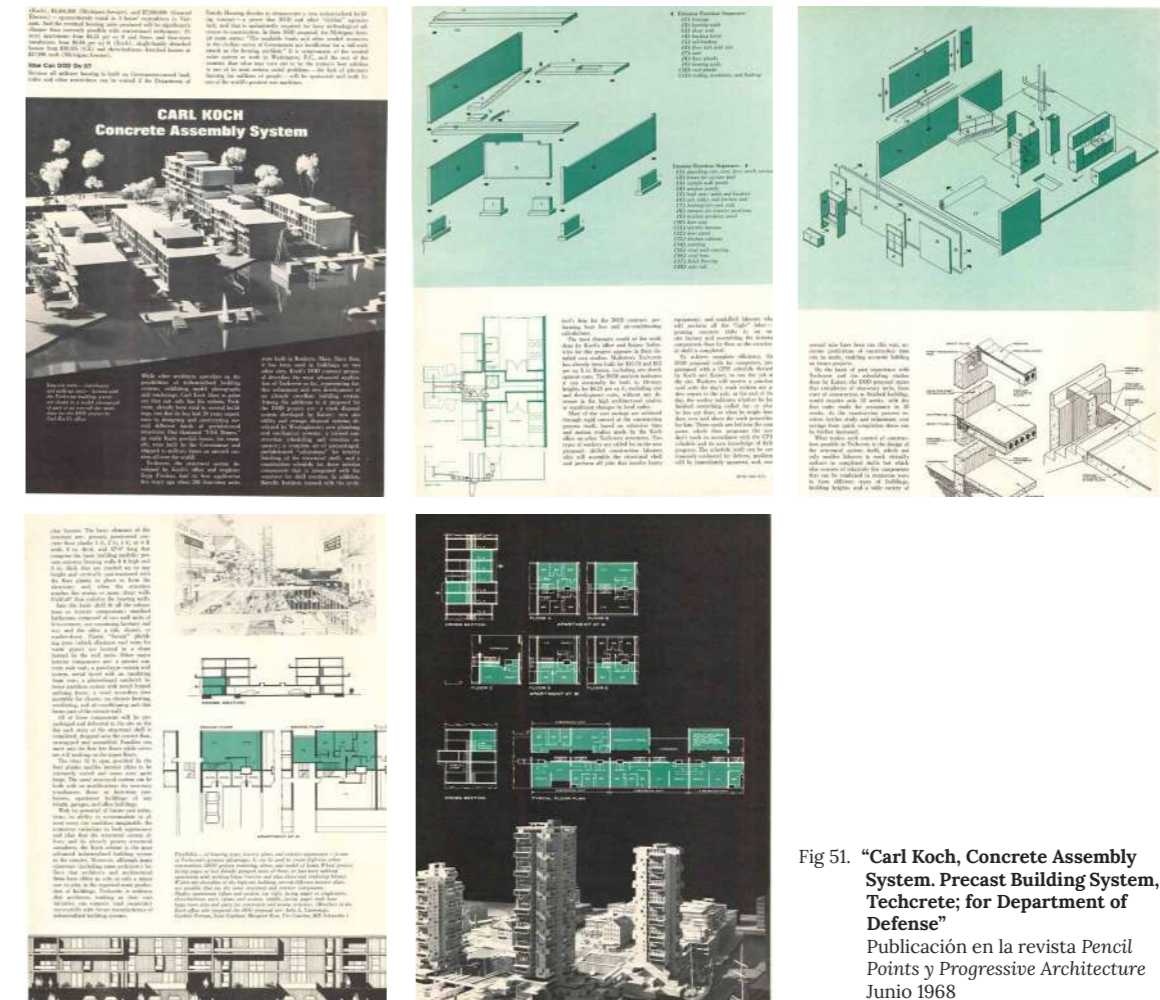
"Carl Koch, Concrete Assembly System. Precast Building System, Techcrete; for Department of Defense" Publicación en la revista *Pencil Points y Progressive Architecture* Junio 1968
